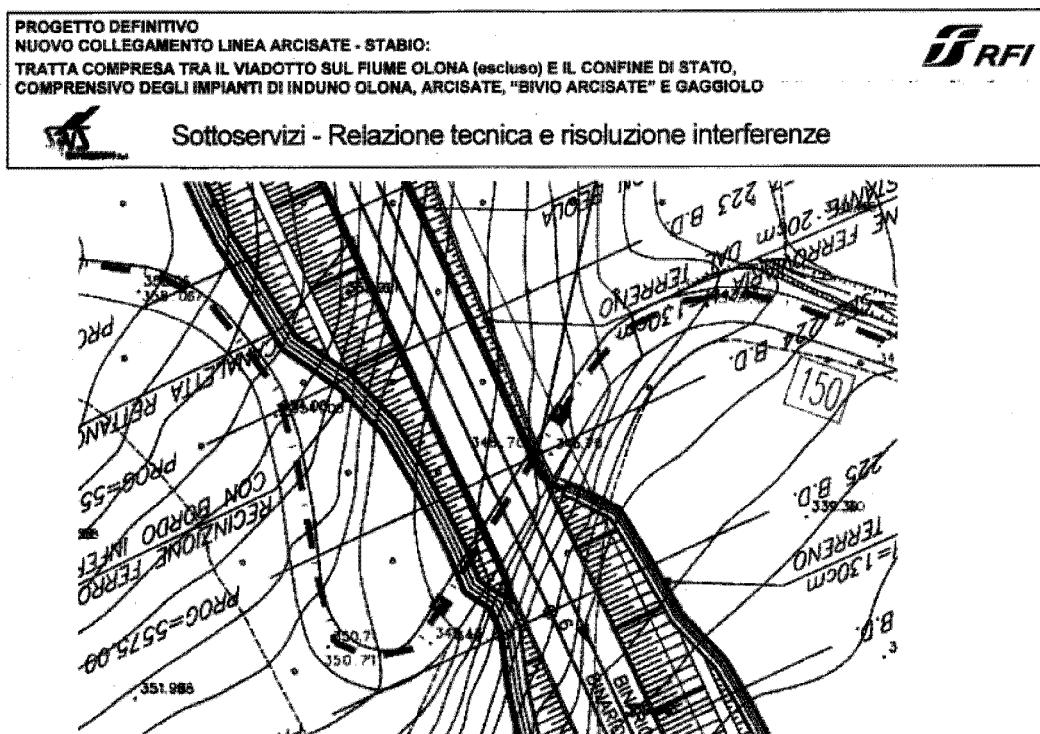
Planimetria dell'interferenza tra la linea ferroviaria e il gasdotto SI 32 029
